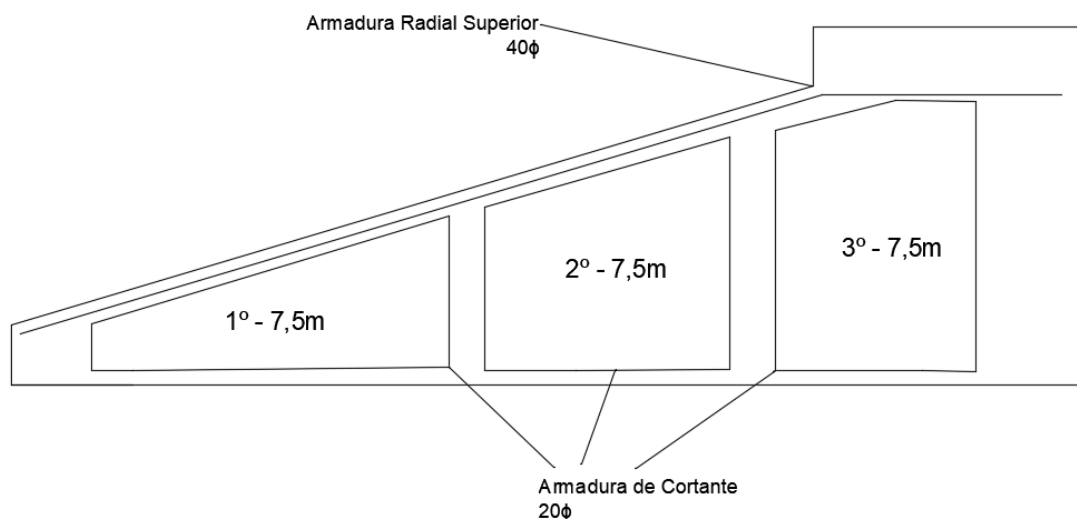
Diseño de sección de armadura radial superior y armaduras de cortante. Fuente: Elaboración propia.
